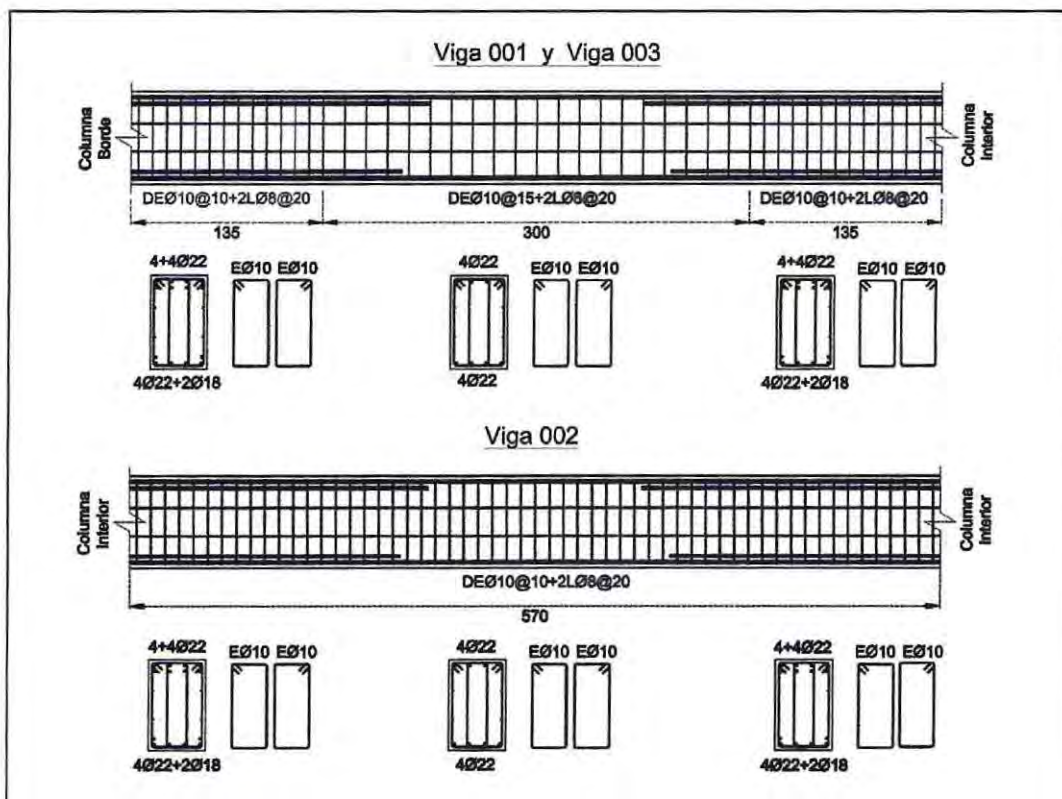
Distribución armadura de corte en vigas Eje 1, estructura con marcos.
